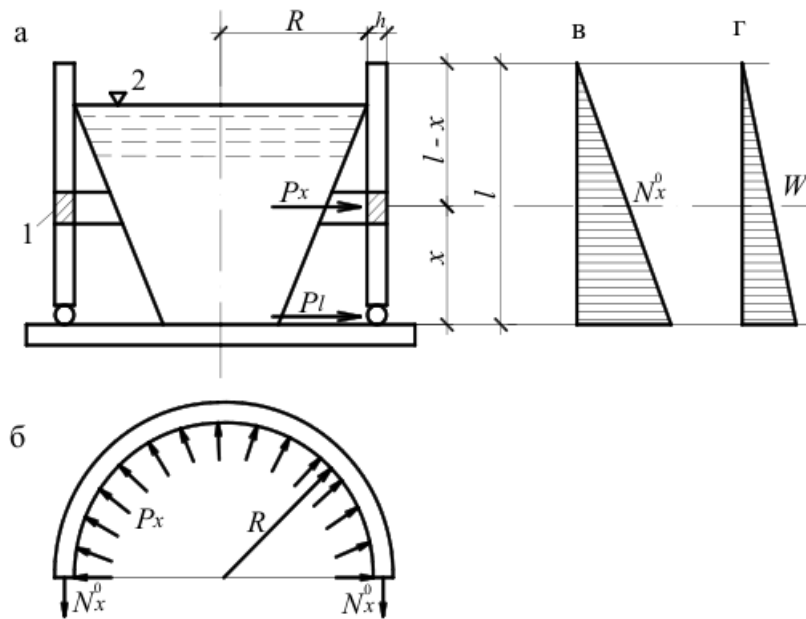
Розрахункова схема циліндричного резервуара:
